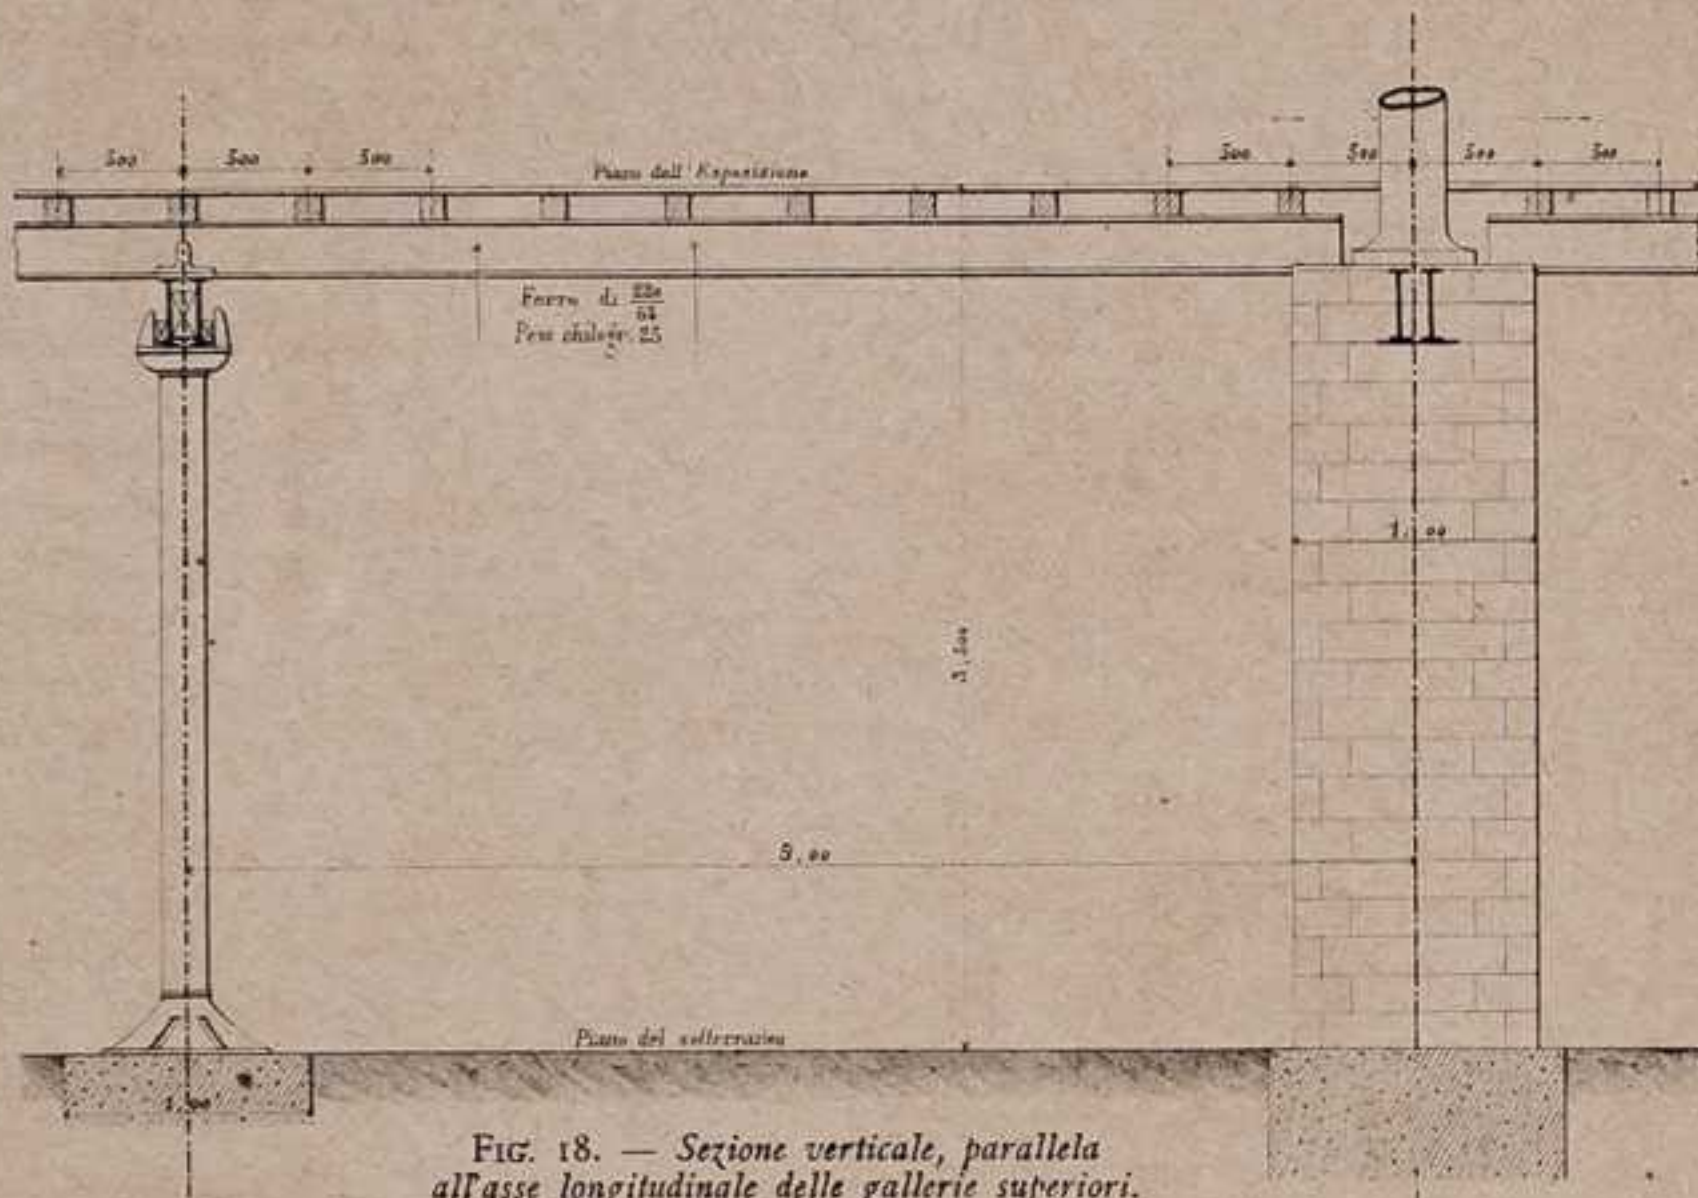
Sezione verticale, parallela all'asse longitudinale delle gallerie superiori.
